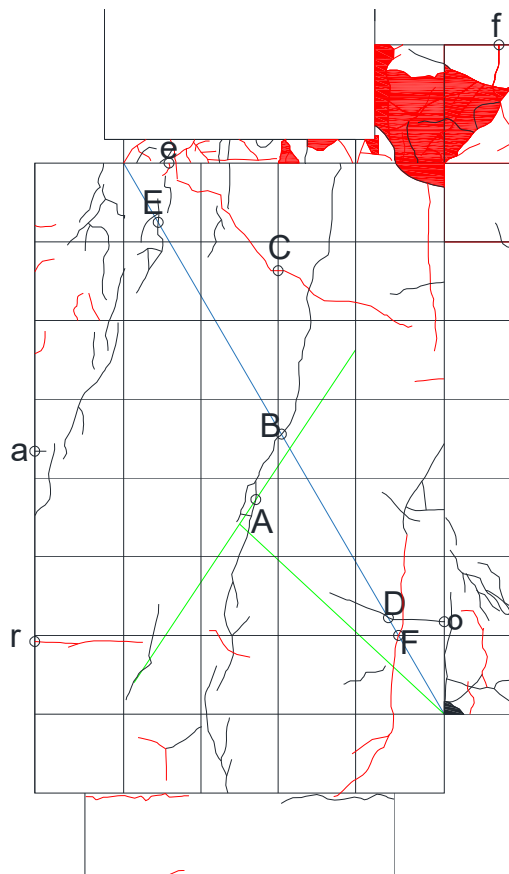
(左) パイルキャップひび割れ測定位置(試験体 E-1 負荷荷)
